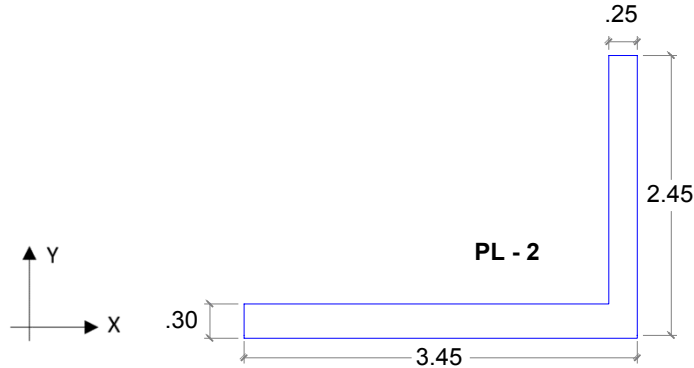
SECCIÓN EN L DEL MURO DE CORTE.
